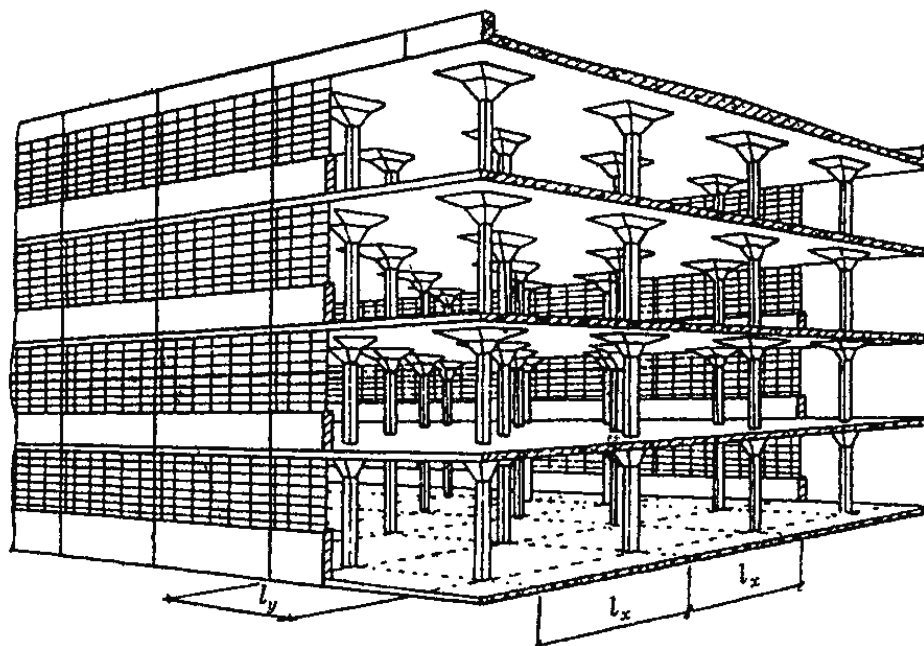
Многоэтажное здание с безбалочными перекрытиями
